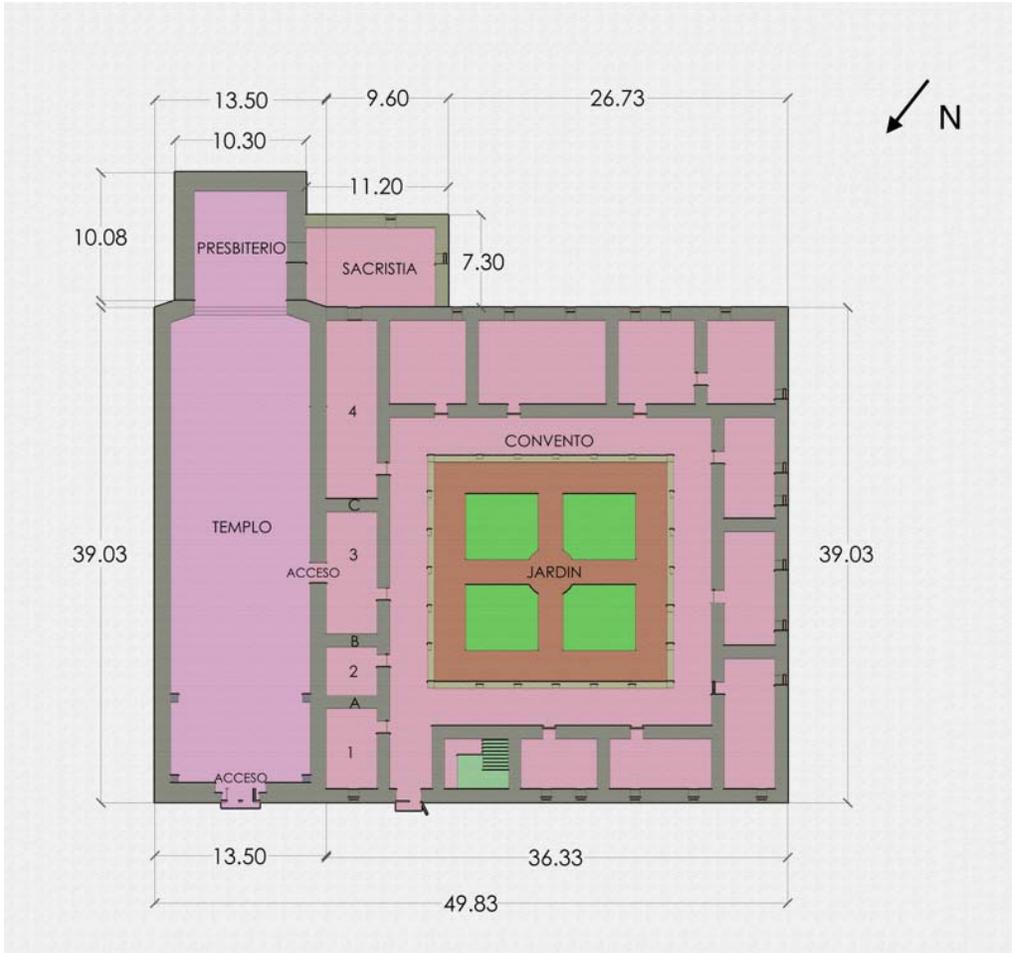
Propuesta planta baja iglesia y convento de San Pedro y San Pablo.
